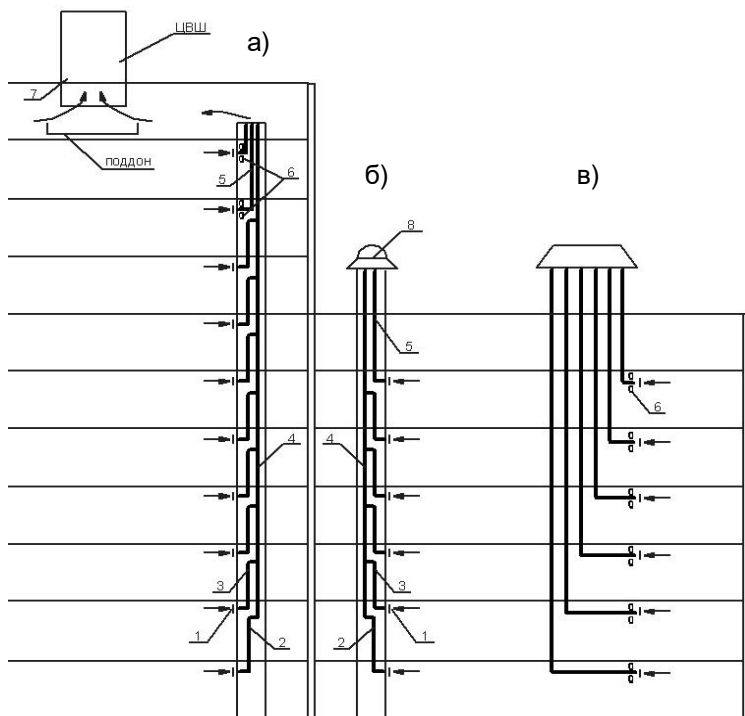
Схема вытяжной естественной и механической вентиляции для многоэтажных (высотных) зданий:
